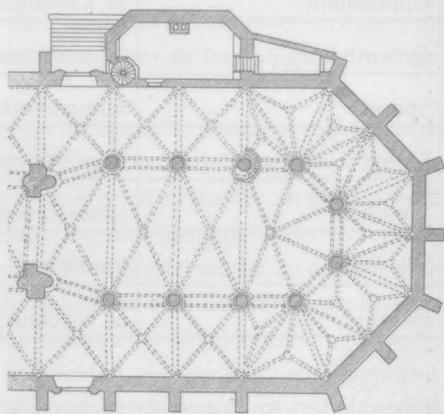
Der Chor der Heiliggeistkirche, Grundriss (Zahn: Heiliggeistkirche, wie Anm. 2, Tafel 2)
